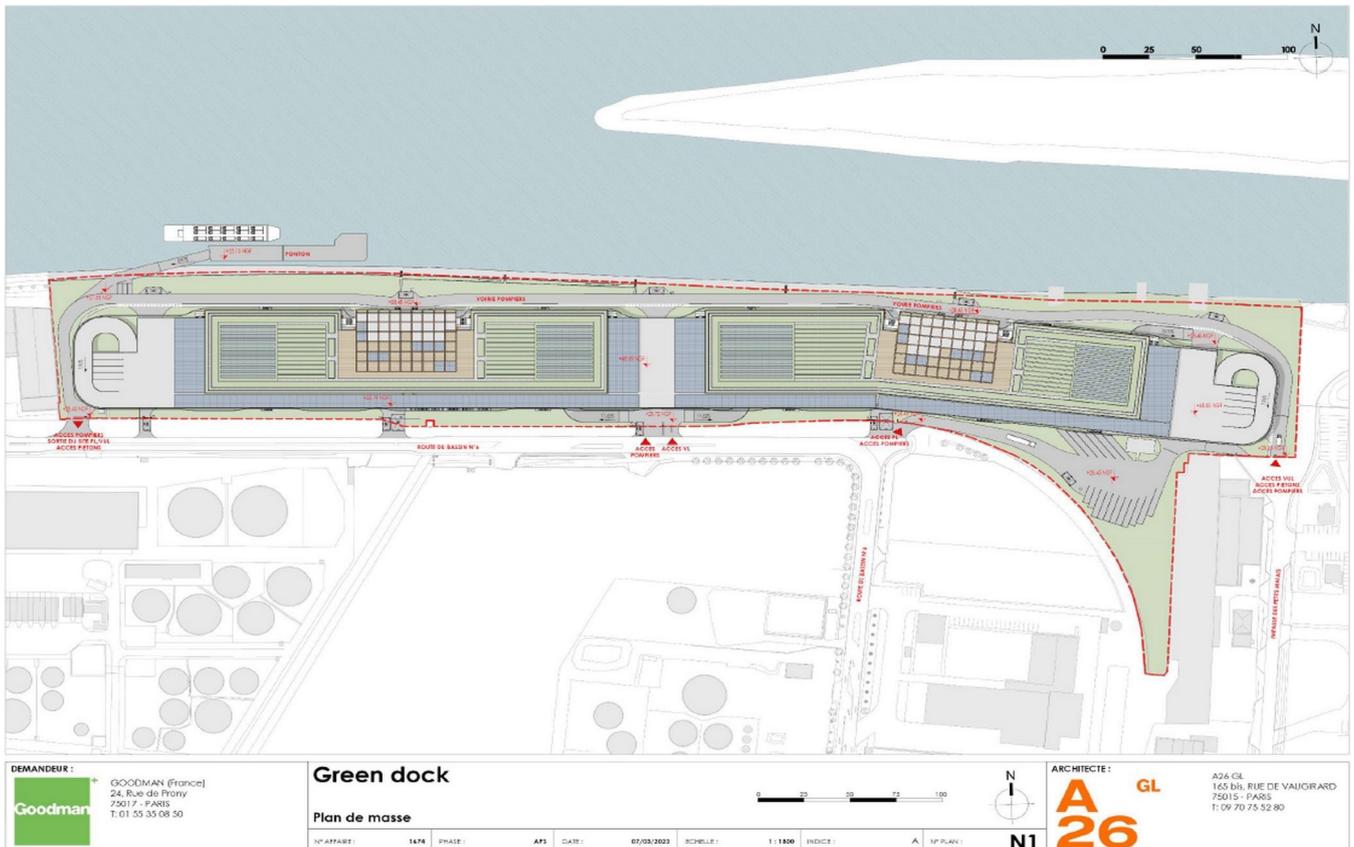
Plan masse du projet (source : Annexe 1 de la note de cadrage)
